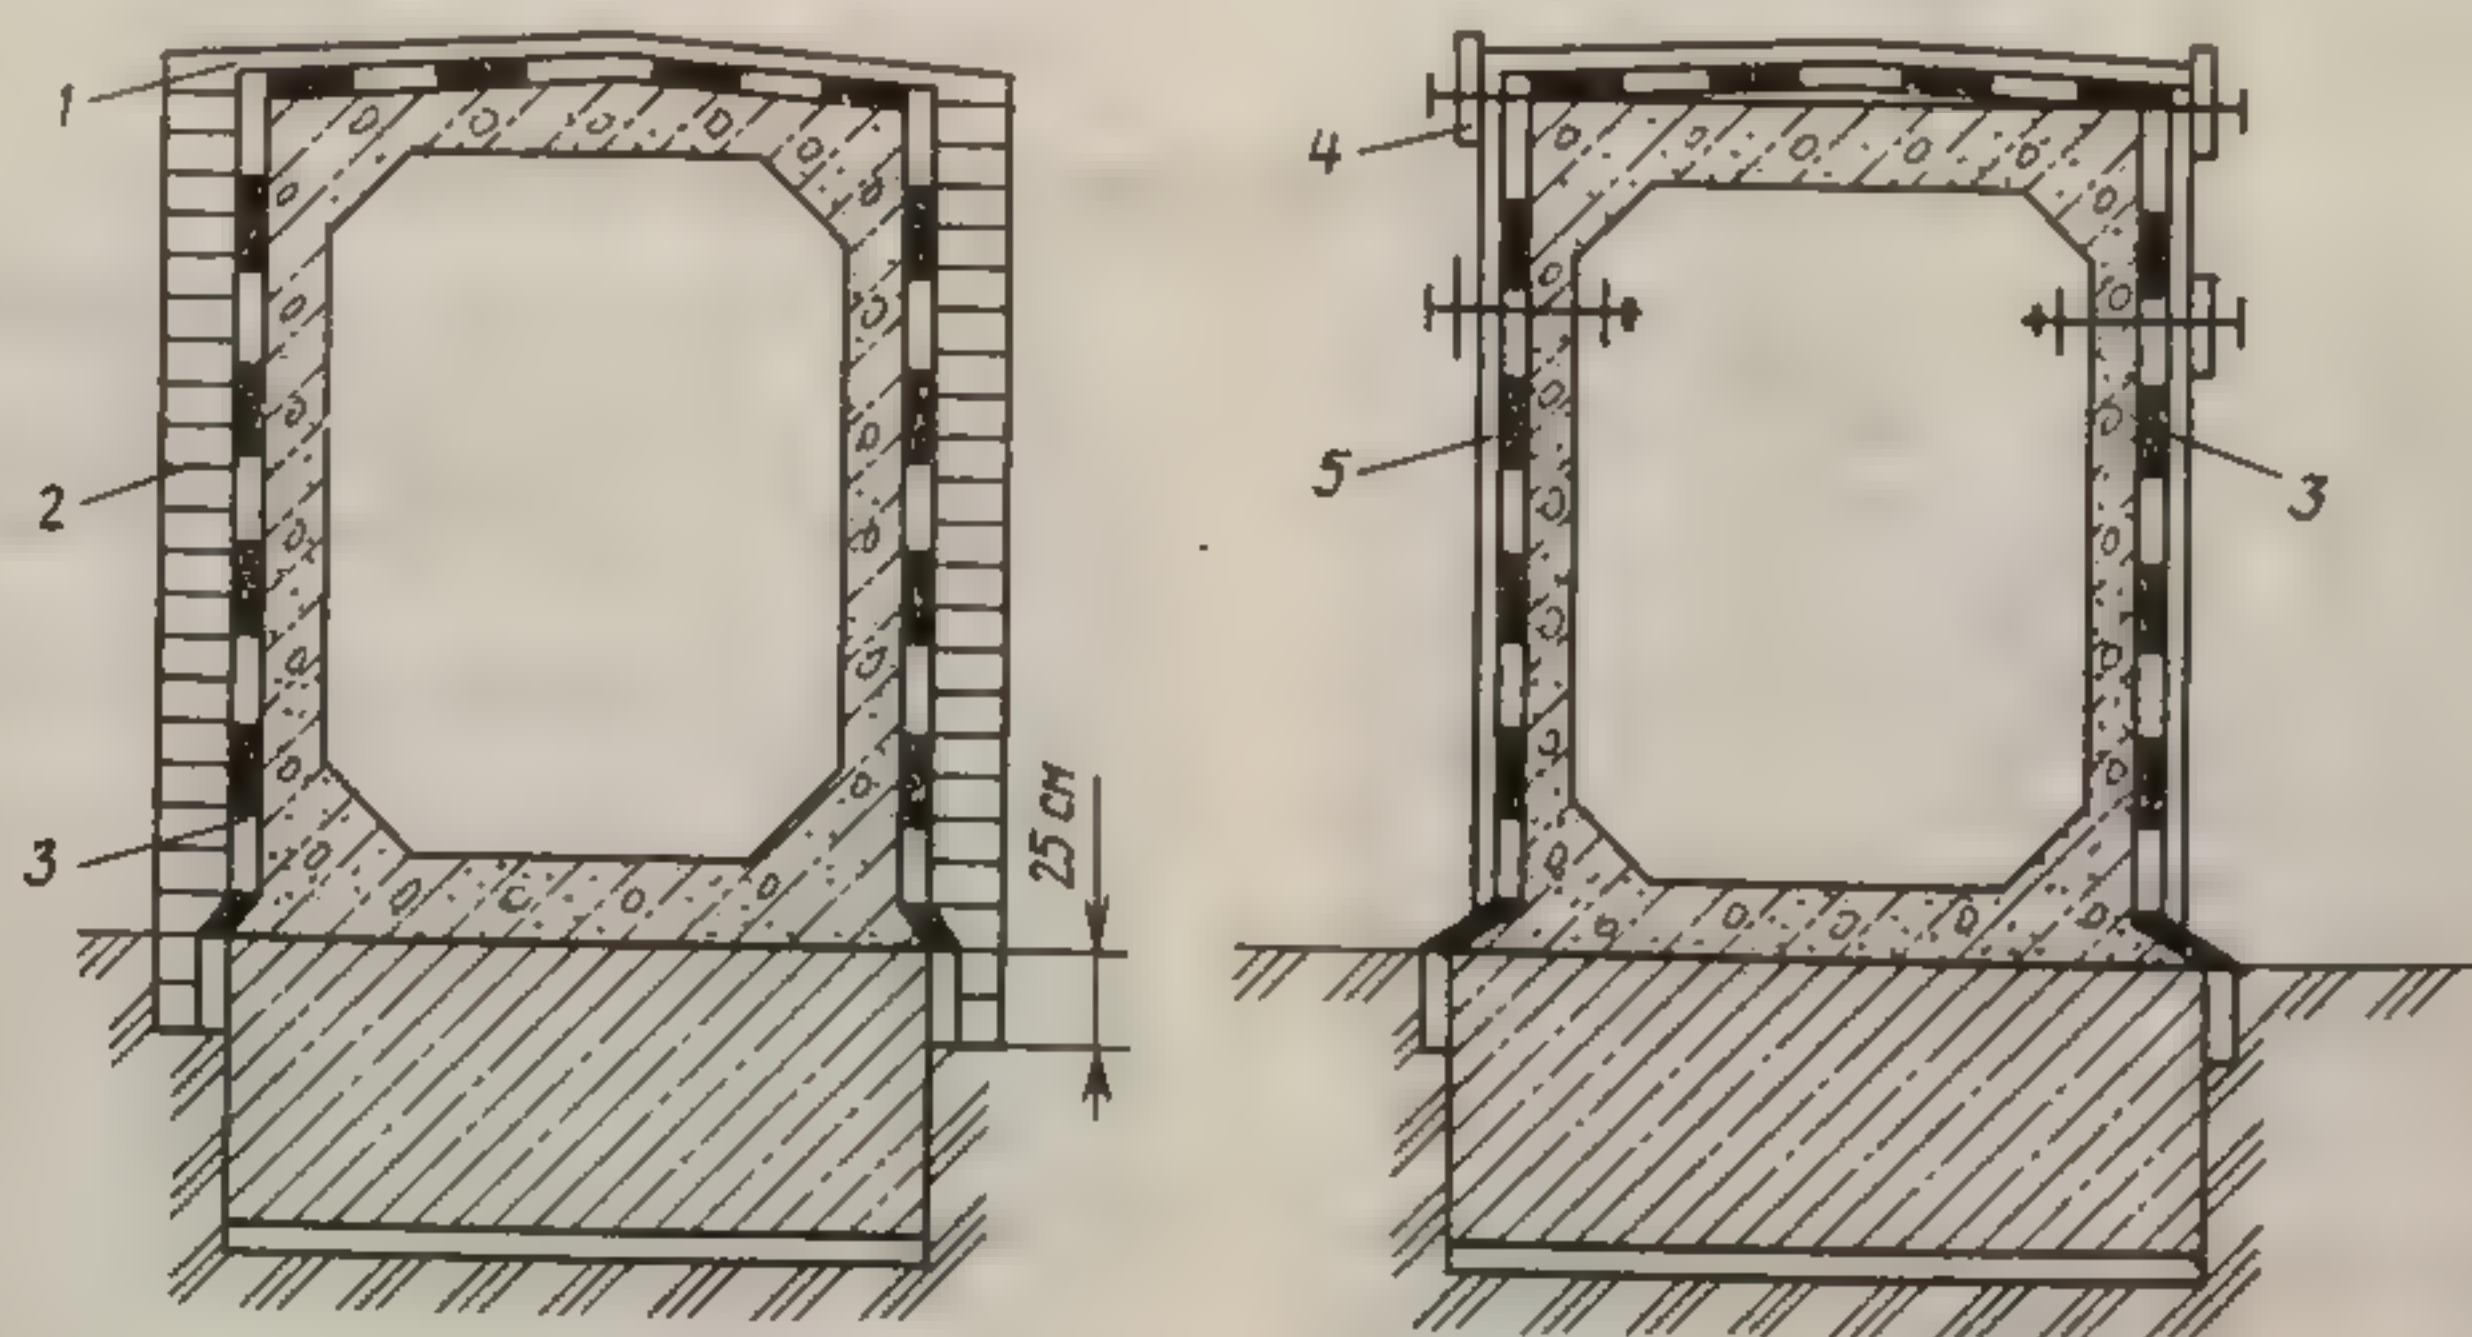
Защита гидроизоляции прямоугольных железобетонных труб
